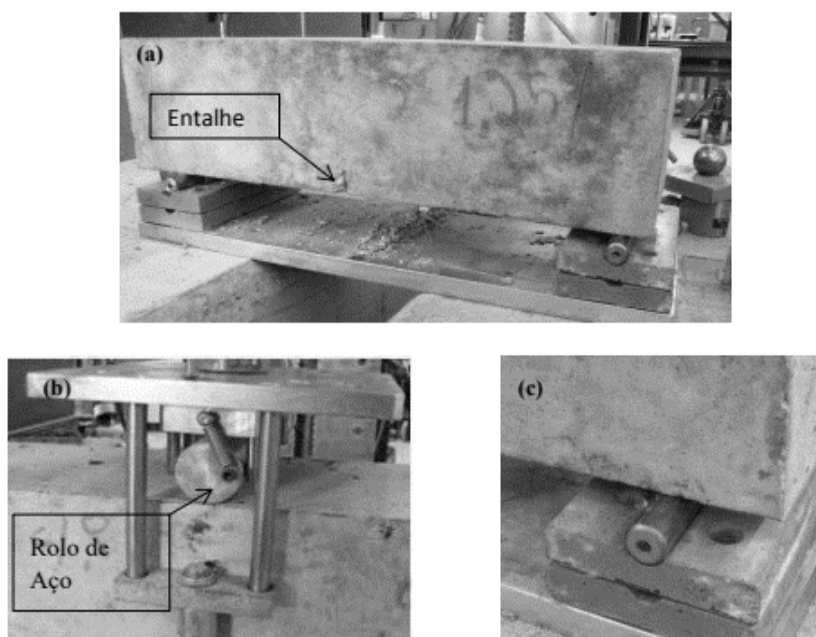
Sistema de ensaio da viga: (a) viga pousada sobre os rolos de aço, (b) sistema de carga sobre a viga e (c) pormenor de um dos apoios (Fernandes, 2012)
